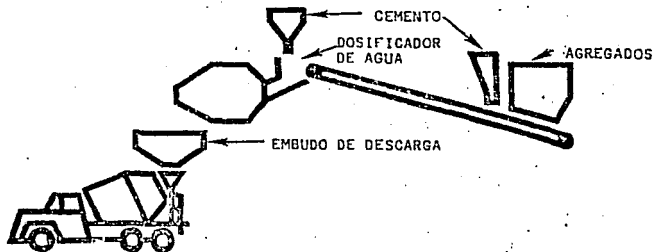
PLANTA DE CONCRETO CON MEZCLADO PARCIAL EN PLANTA
